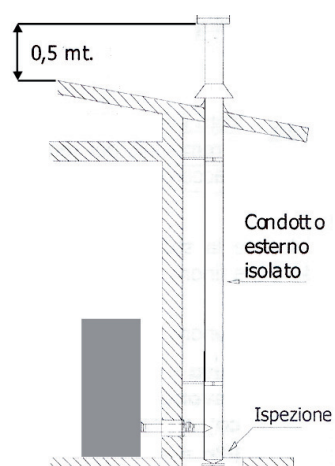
collegamento ad un condotto esterno con tubo isolato o doppia parete
